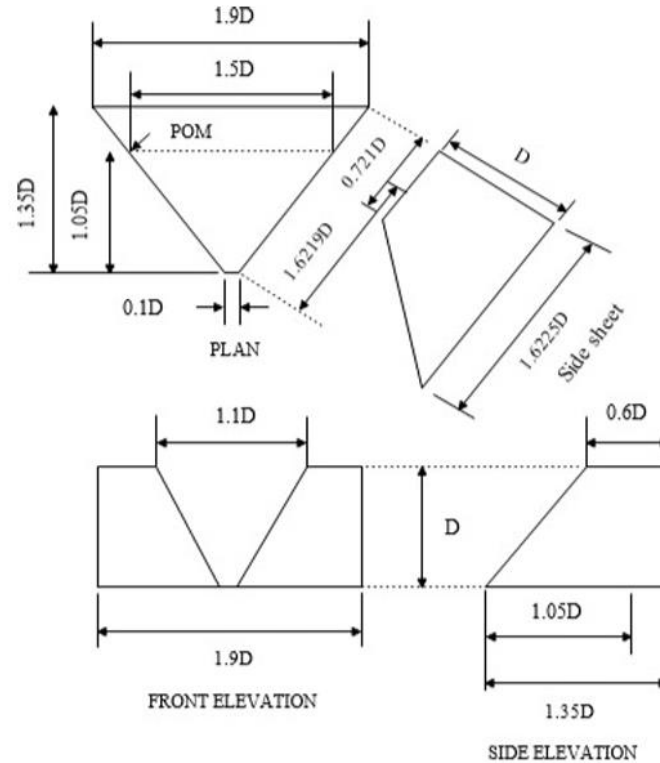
Vista en planta y alzada frontal de canal H (Sibale et al., 2023)
